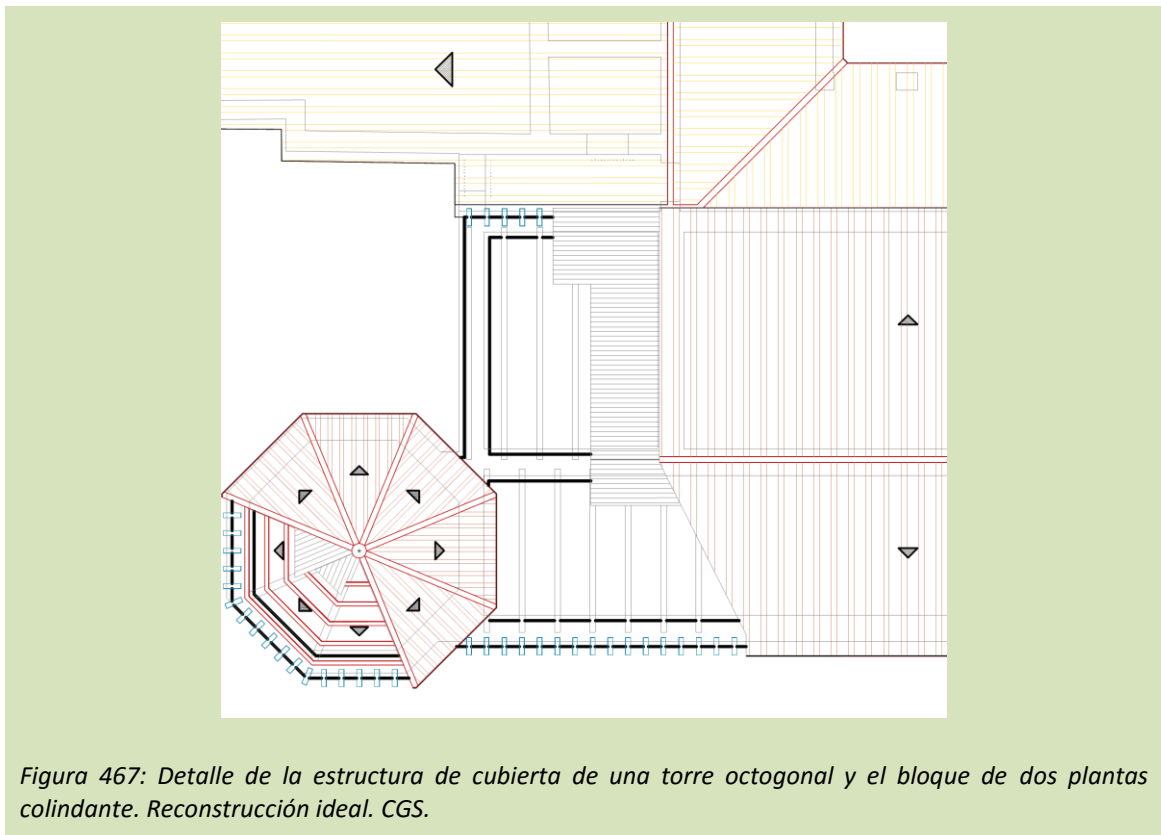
Detalle de la estructura de cubierta de una torre octogonal y el bloque de dos plantas colindante. Reconstrucción ideal. CGS.
